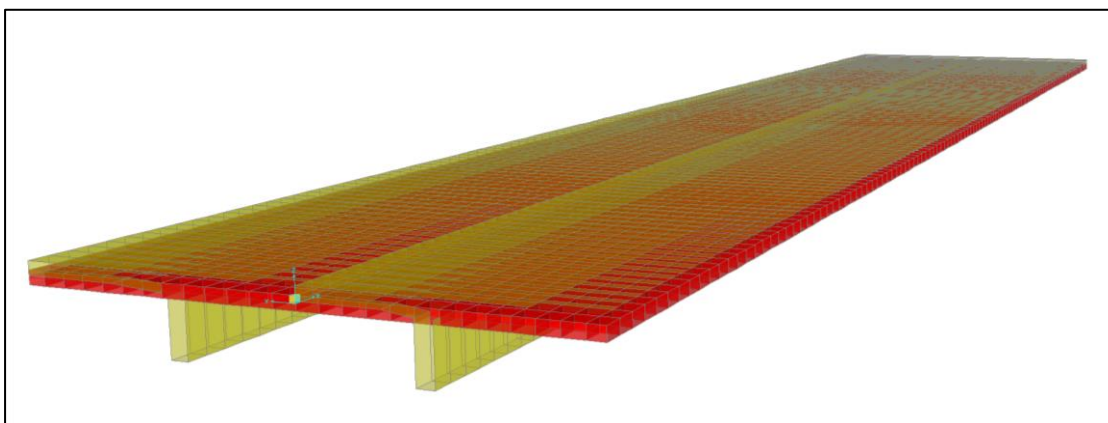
CASO 3 - Visualização da seção transversal do tabuleiro com adição de elementos de laje para unificação das vigas longitudinais. (SAP-2000)
